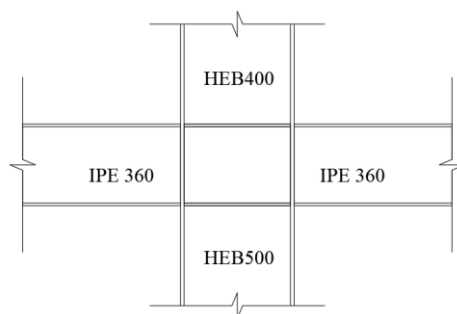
Conexión RBS Columna B2 Piso 3.
